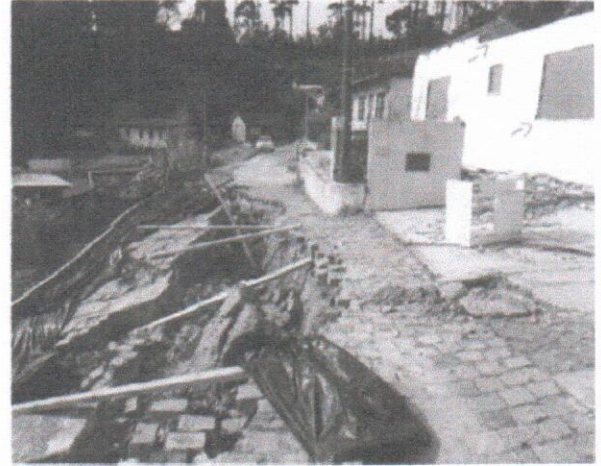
O desmoronamento não atingiu a estrutura da edificação que apresenta trincas e rachaduras que podem também ter ocorrido quando foram retiradas as janelas e cobertura. (Fonte: extraído de Laudo D.C. de São Bento do Sul n.128/2014, jun. 2014).
